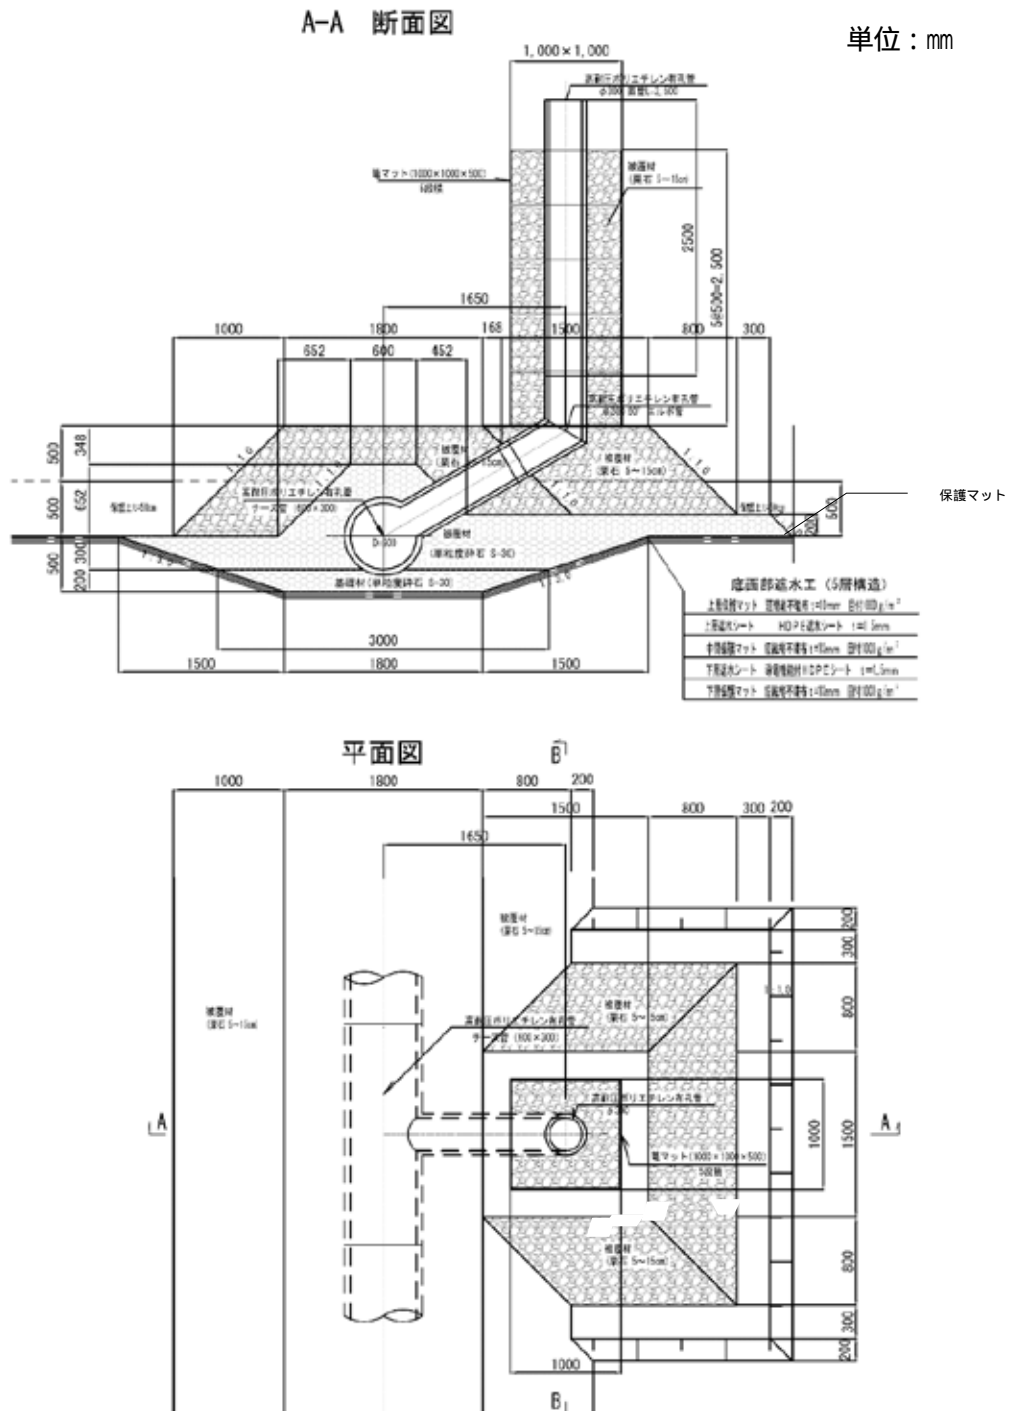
豎型浸出水集排水管 標準断面図・平面図
